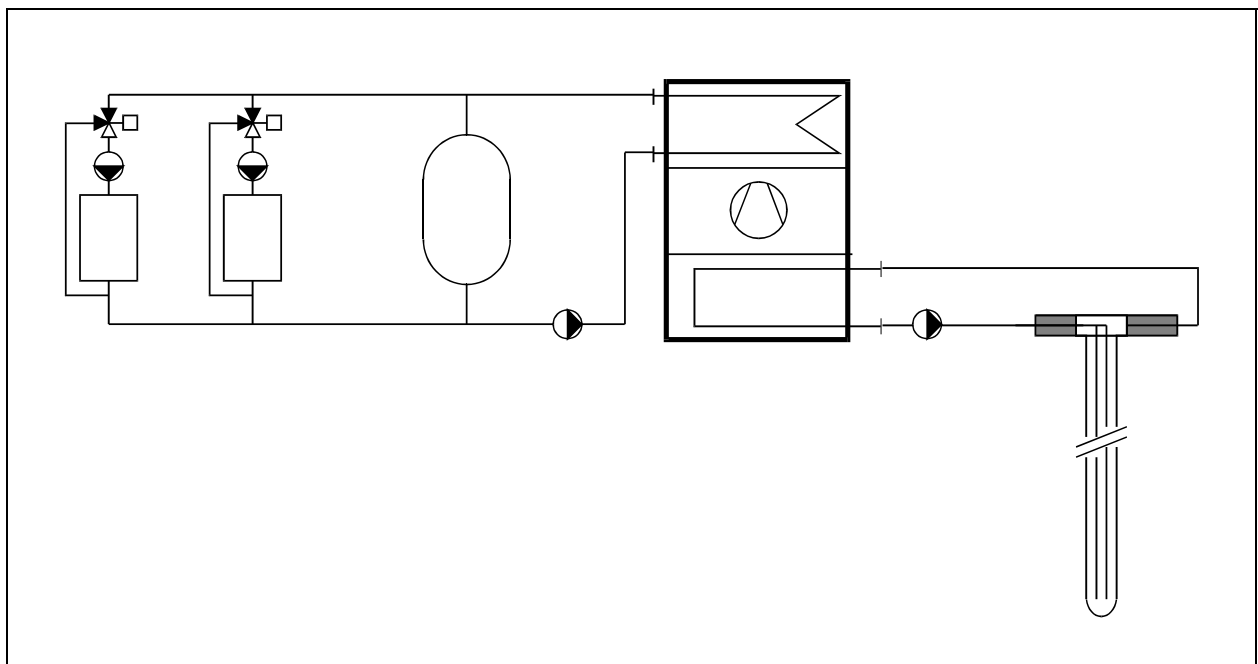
Schema einer Erdwärmesonden-Wärmepumpenanlage. Standardschaltung nach RAVEL für taktenden Teillastbetrieb. Grundschaema für den Kosten-Nutzen-Vergleich
